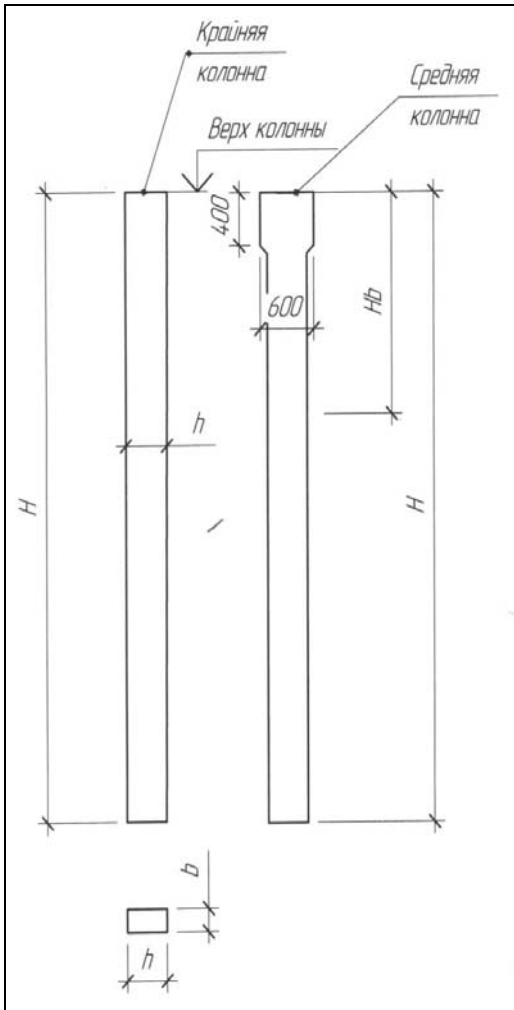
Конструкция колонн для зданий без мостовых кранов
